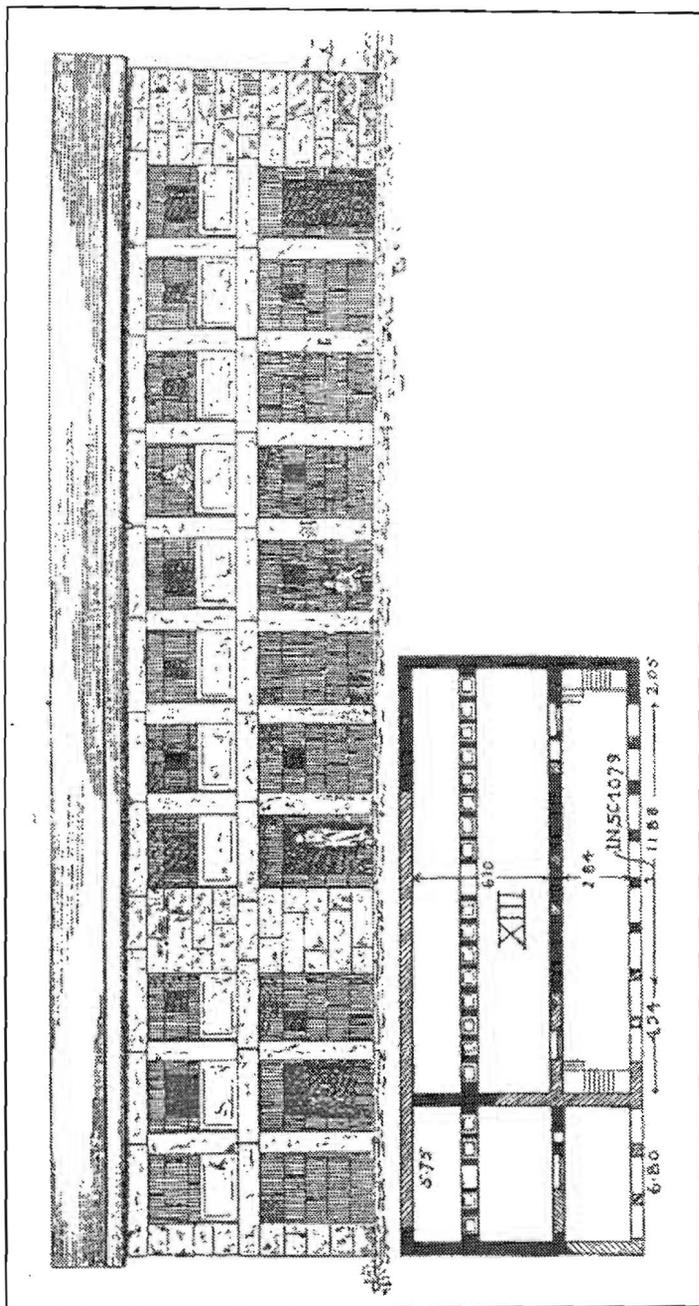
Pianta e prospetto del pandokeion di Dar Kita (da TCHALENKO 1953).
